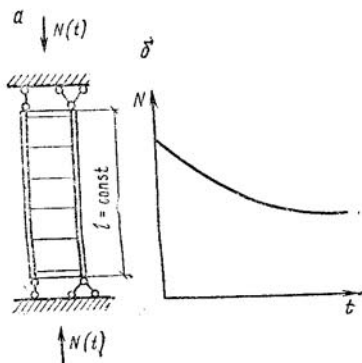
Релаксация напряжений в бетоне при постоянных напряжениях в арматуре железобетонной призмы
